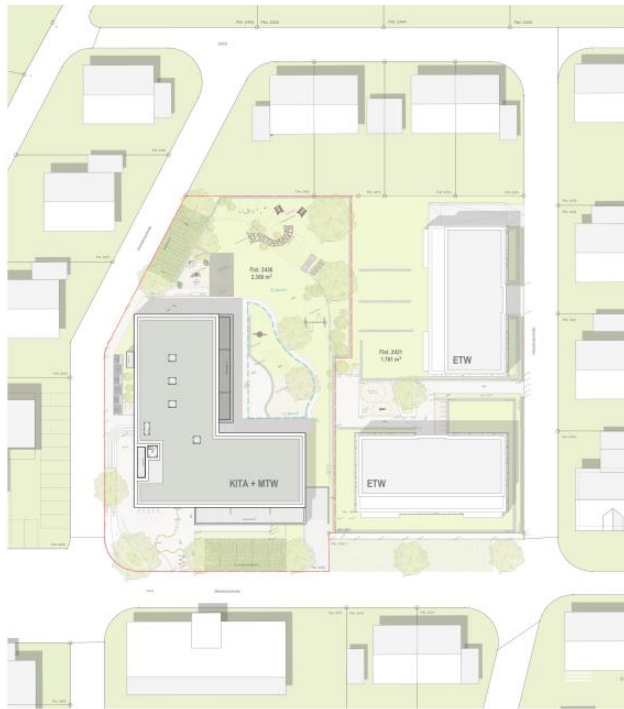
Bebauungsplan „Hanfäcker-1. Änderung“ (Auszug) vom 23.04.2020.
